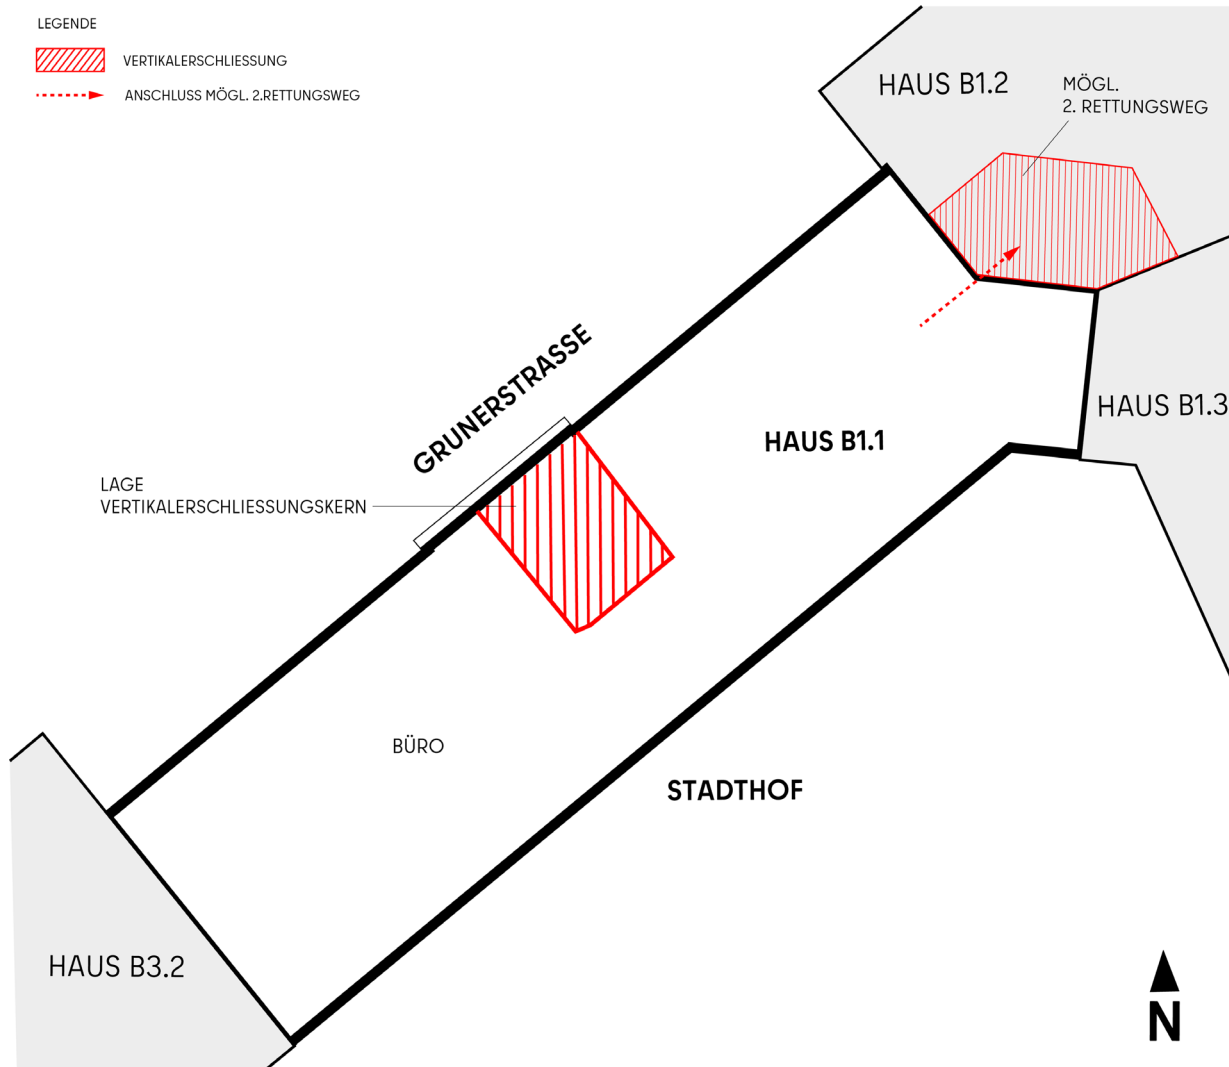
Schematischer Grundriss Regelgeschoss Büros
